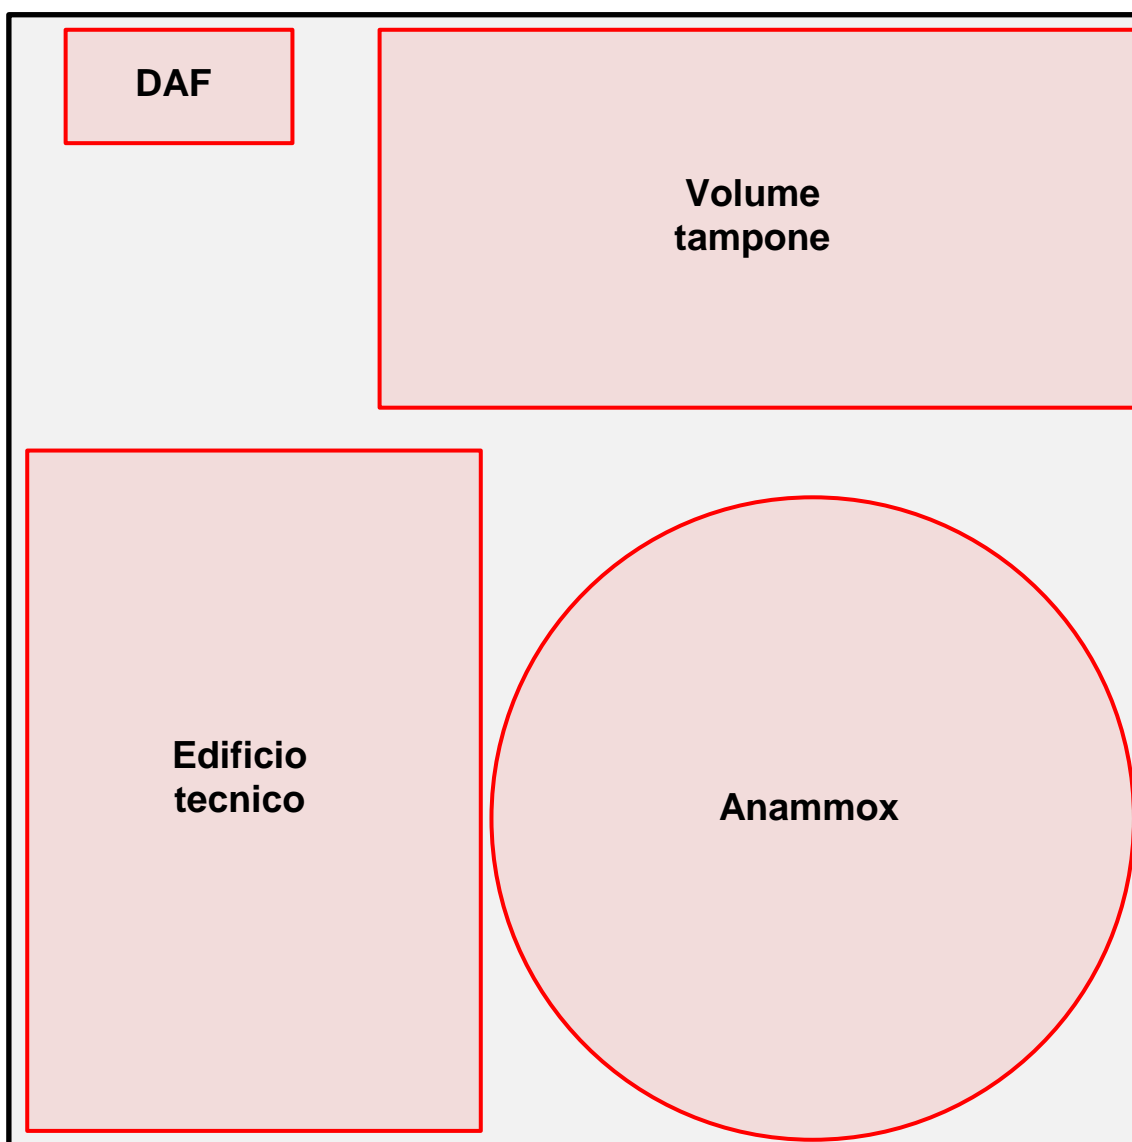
Ipotesi di disposizione delle apparecchiature costituenti il sistema di pretrattamento
